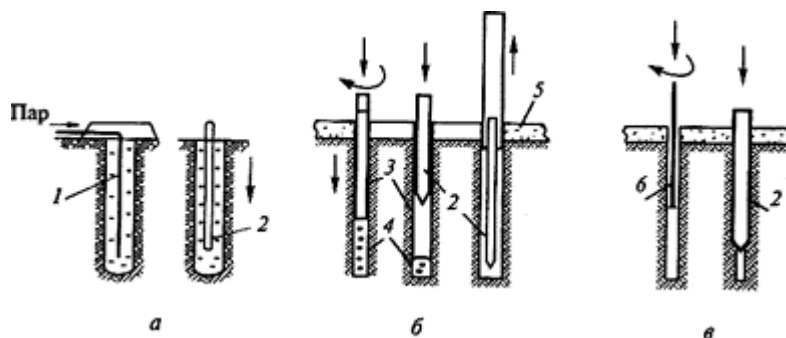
Схемы погружения свай в вечномерзлые грунты:
